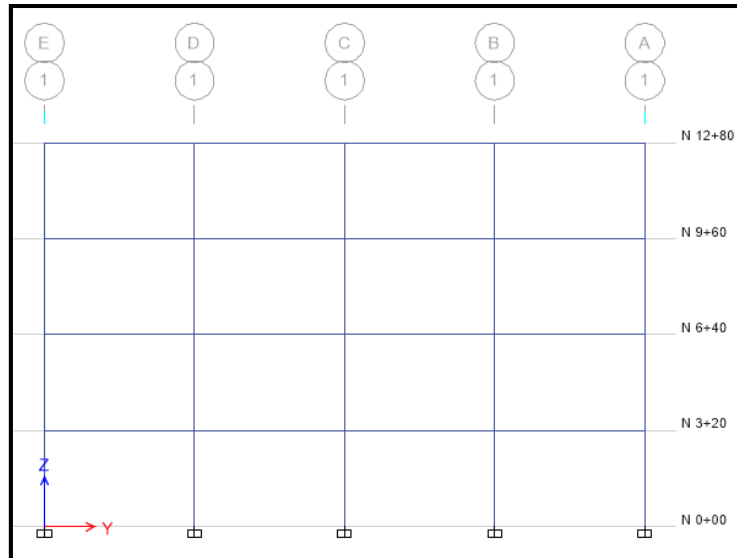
Elevación vista en el plano Y-Z con Pórticos resistentes a momento.
